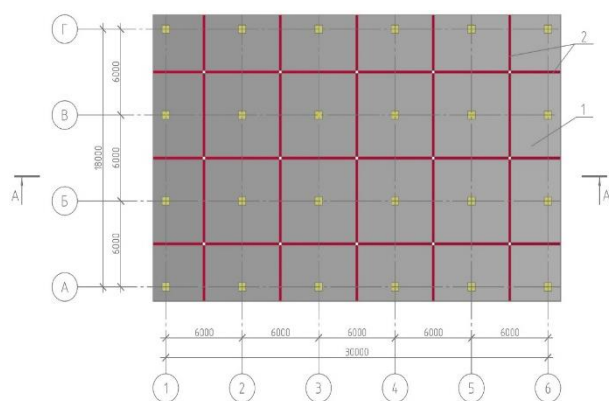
Конструкция фундаментной плиты с регулируемыми усилиями, план:
